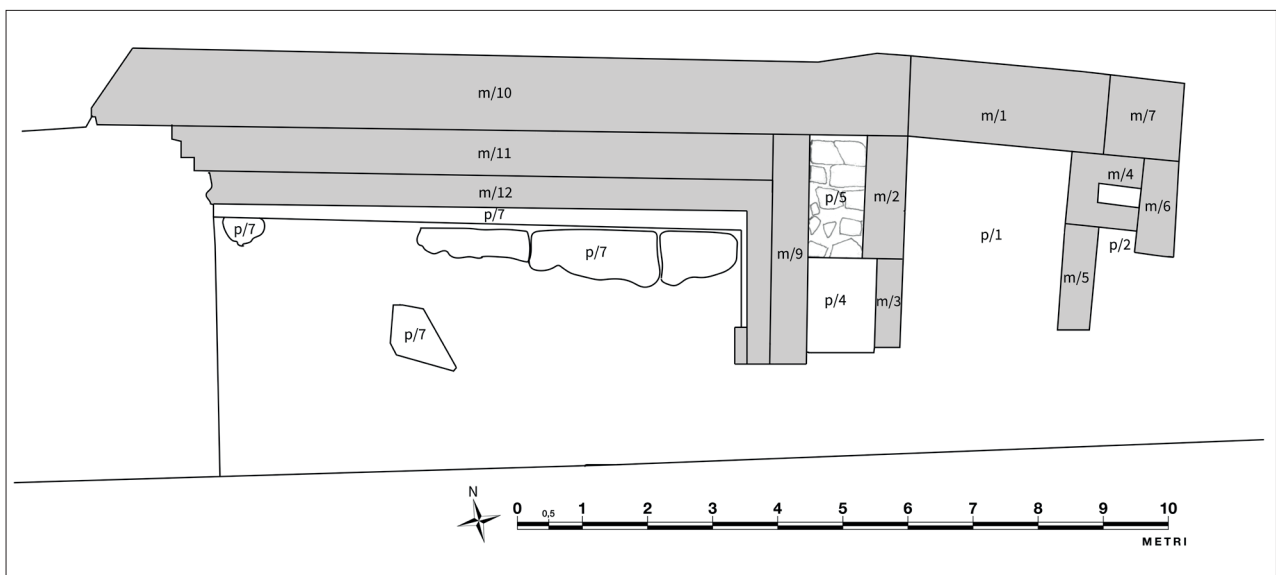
Pianta schematica delle strutture attribuite alla Fase costruttiva 4 dell'edificio
